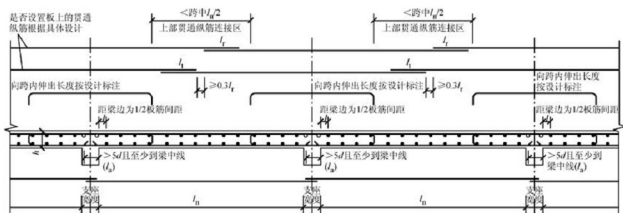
楼面板 LB 和屋面板 WB 钢筋构造
